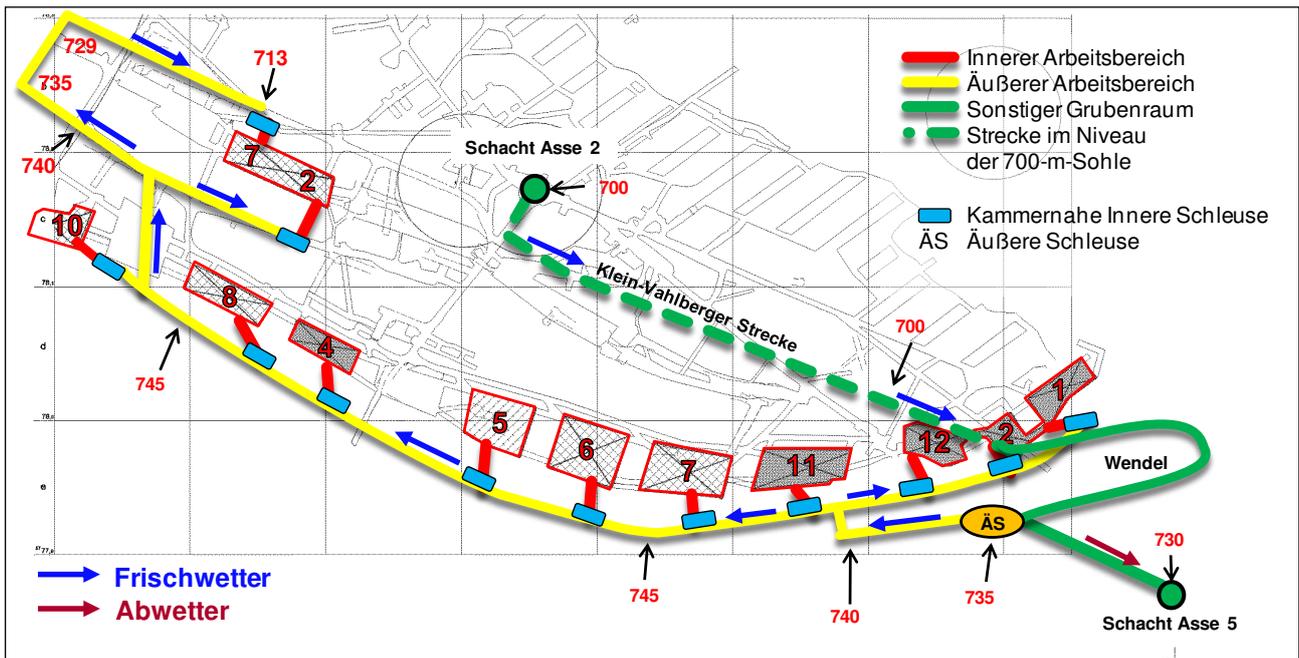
Beispielhafte Darstellung der Wetterwege für die Variante 5 mit kammernahen Inneren Schleusen und Wendel (Hintergrund: Grundriss der 750-m-Sohle)
